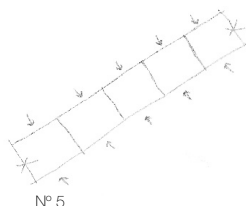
Boceto en planta de la disposición de la construcción situada en la Rúa Moaña-Coia, nº 5 (autoría propia).
